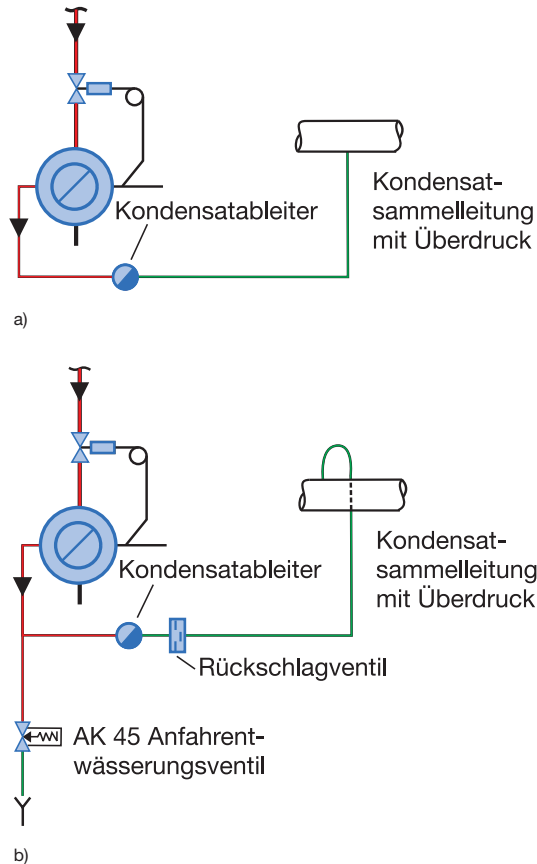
Wasserschläge in dampfseitig geregelten liegenden Gegenströmern
